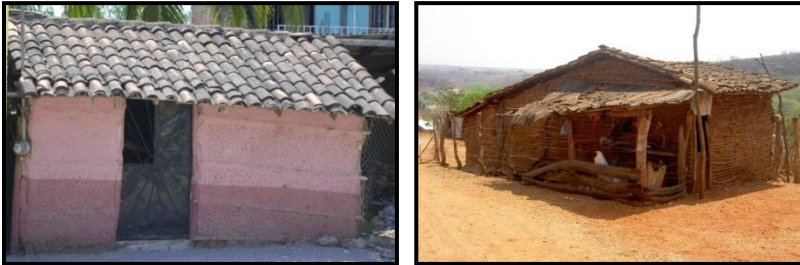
Construcciones de bajareque en las áreas periurbanas y rurales de Tuxtla Gutiérrez.
